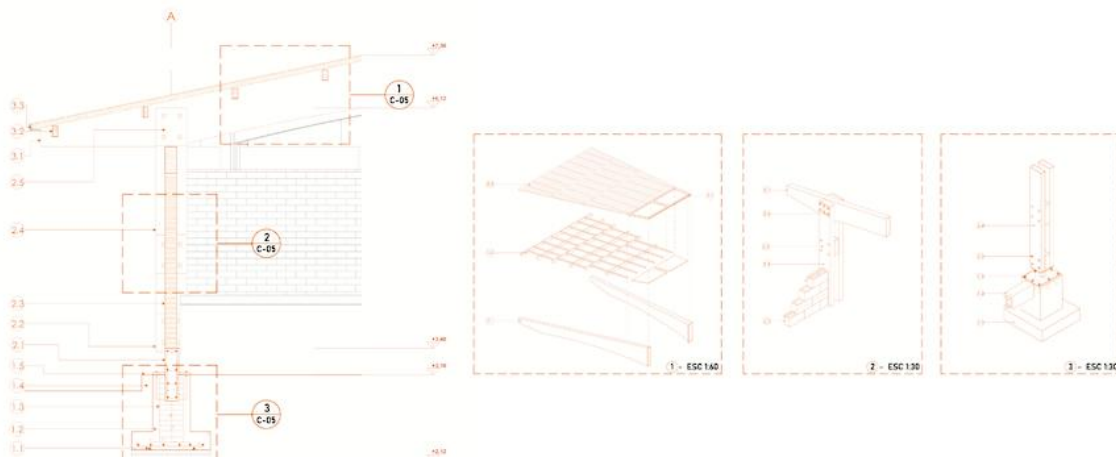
Detalles de asesoría constructiva. (Montesdeoca C., 2025)
